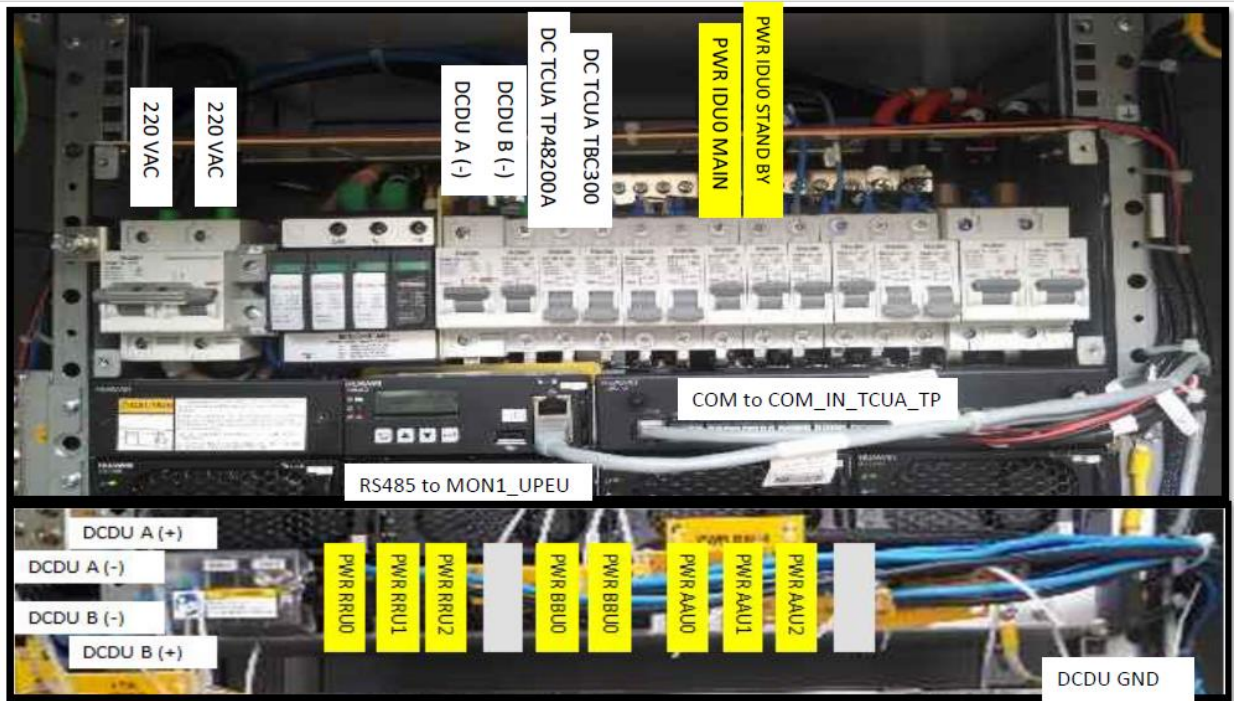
Etiquetado en la DCDU, Breakes, Site Santa Teresa
